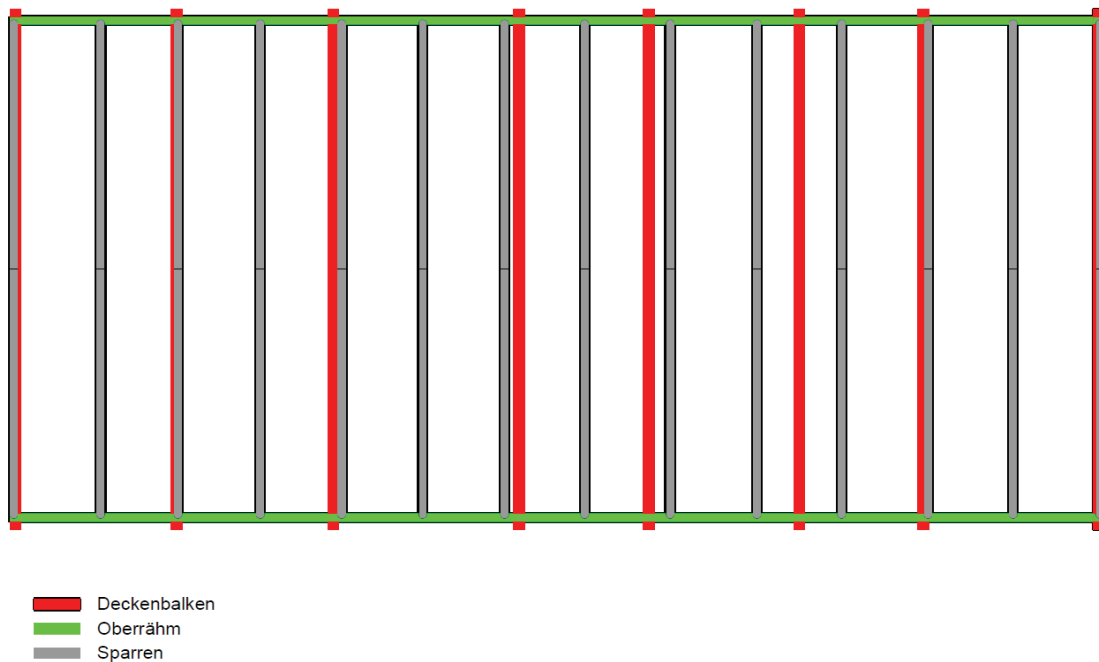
Detailpunkt Sparrenaufleger an Rähm und Deckenbalken
